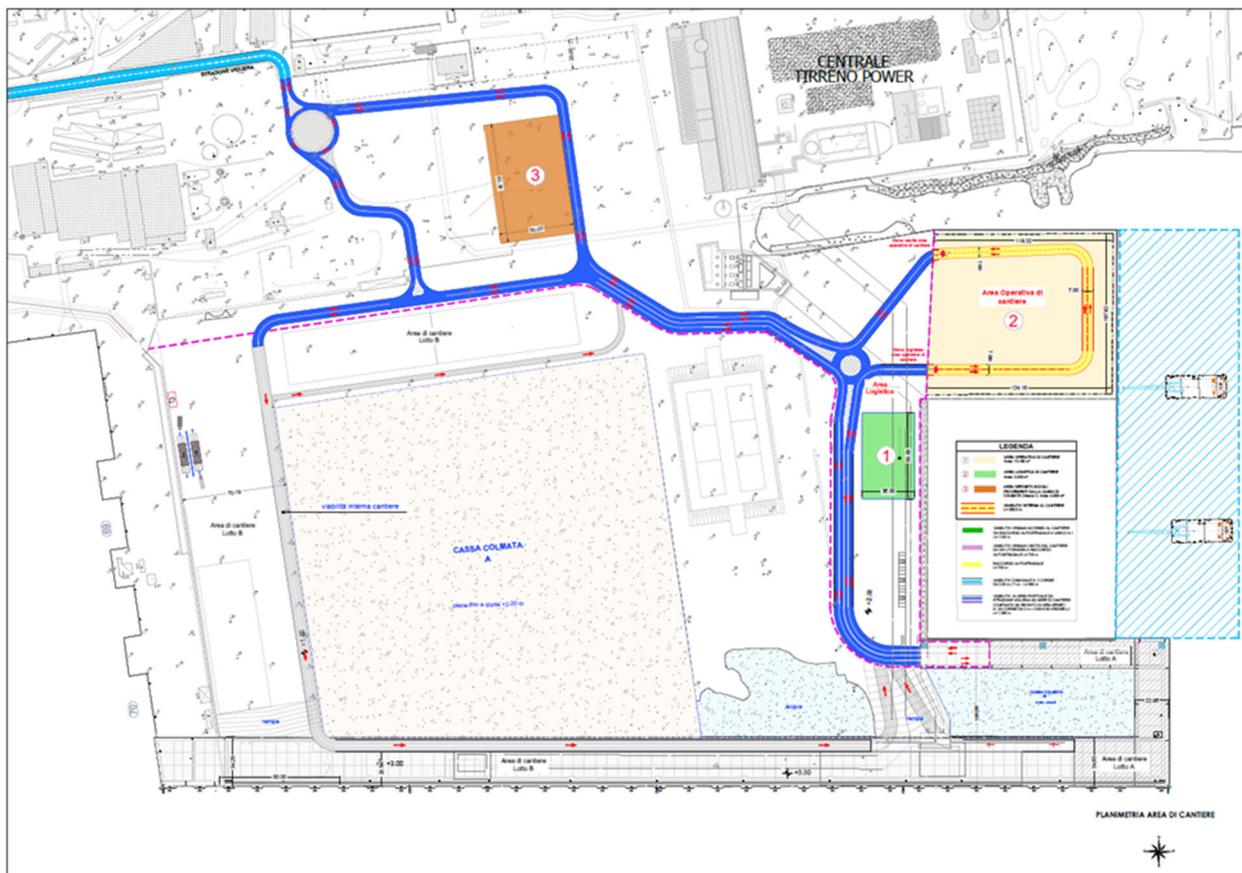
Planimetria delle aree di cantiere, della logistica e della viabilità di cantiere (elaborato MI061P-PDDS4030)
